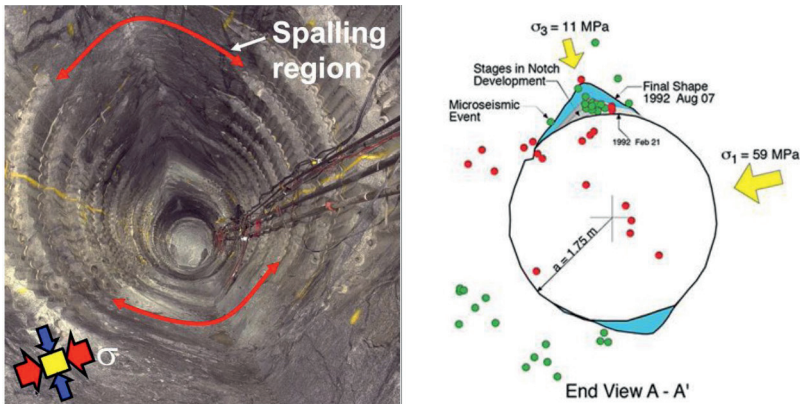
Esempio e schematizzazione del fenomeno di spalling (Martin D. 2019)
